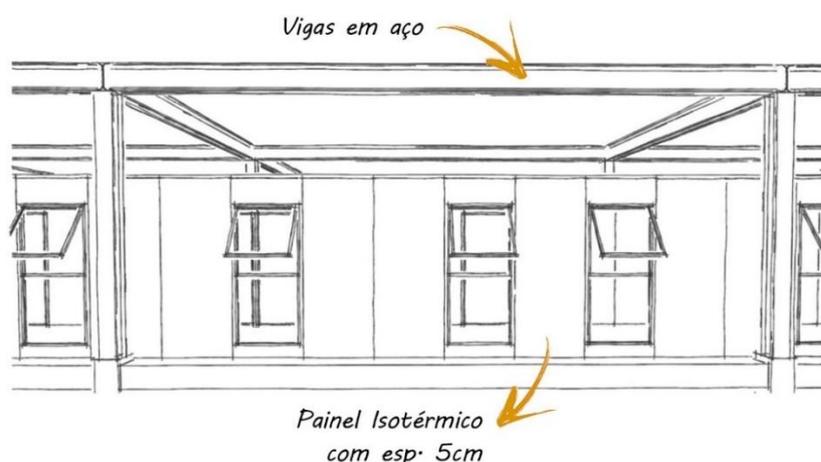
Croqui esquemático das conexões entre os pilares e as vigas metálicas.
